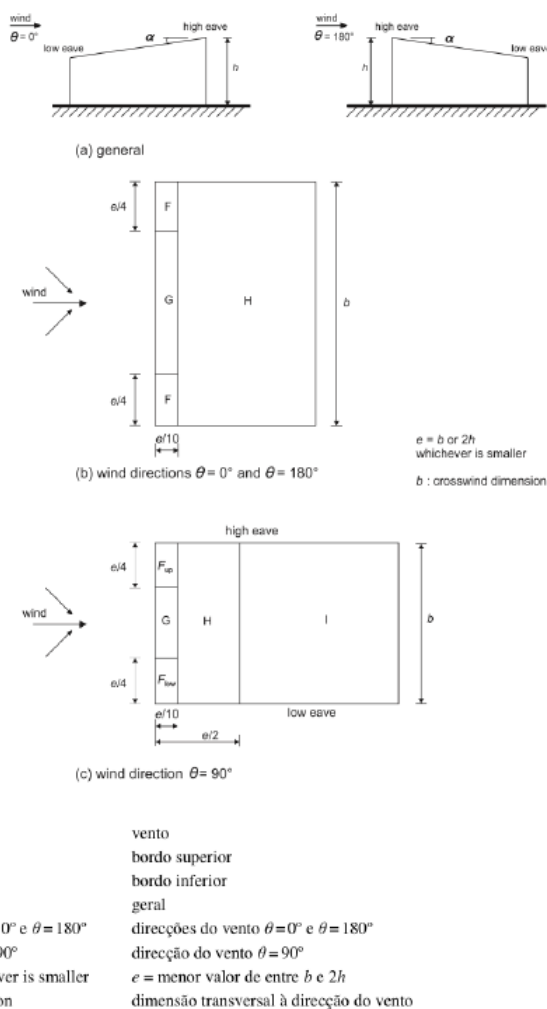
Zonas em coberturas de uma vertente. [7]
